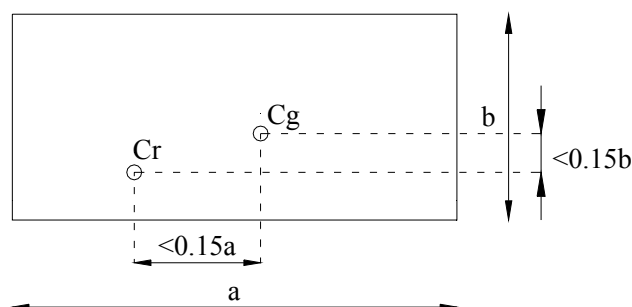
Condição de distribuição proporcionada da massa e da rigidez em planta.
